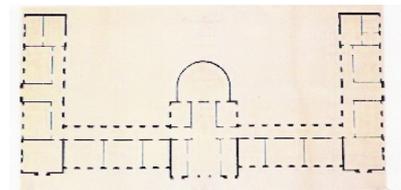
Planta original do pavimento térreo (1894) da Escola Normal São Paulo Ramos de Azevedo.
